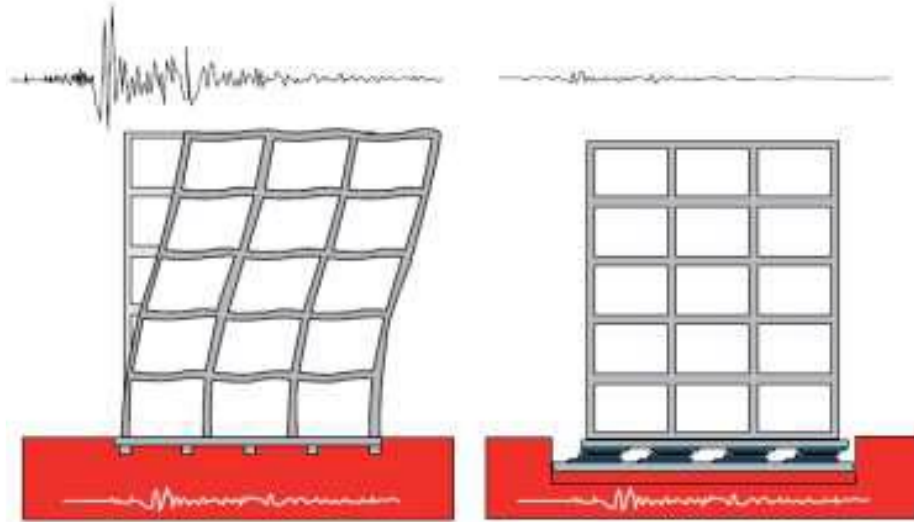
Sistema estructural sin aislamiento en su base y sistema estructural con aislamiento en su base, respectivamente (fuente: Protección Sísmica de Estructuras, Cámara Chilena de la Construcción).
